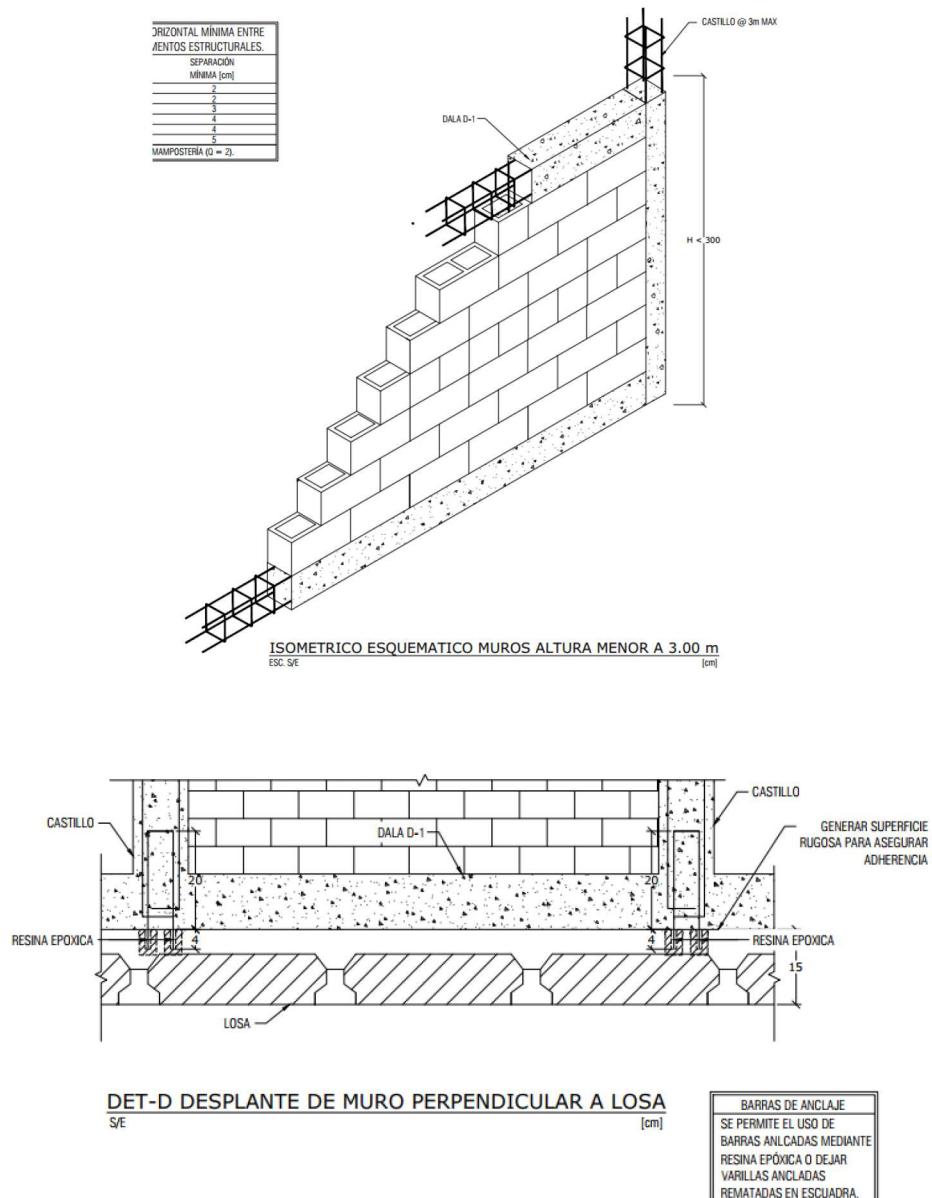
isométrico de muro y desplante de muro en losa de entrepiso.
